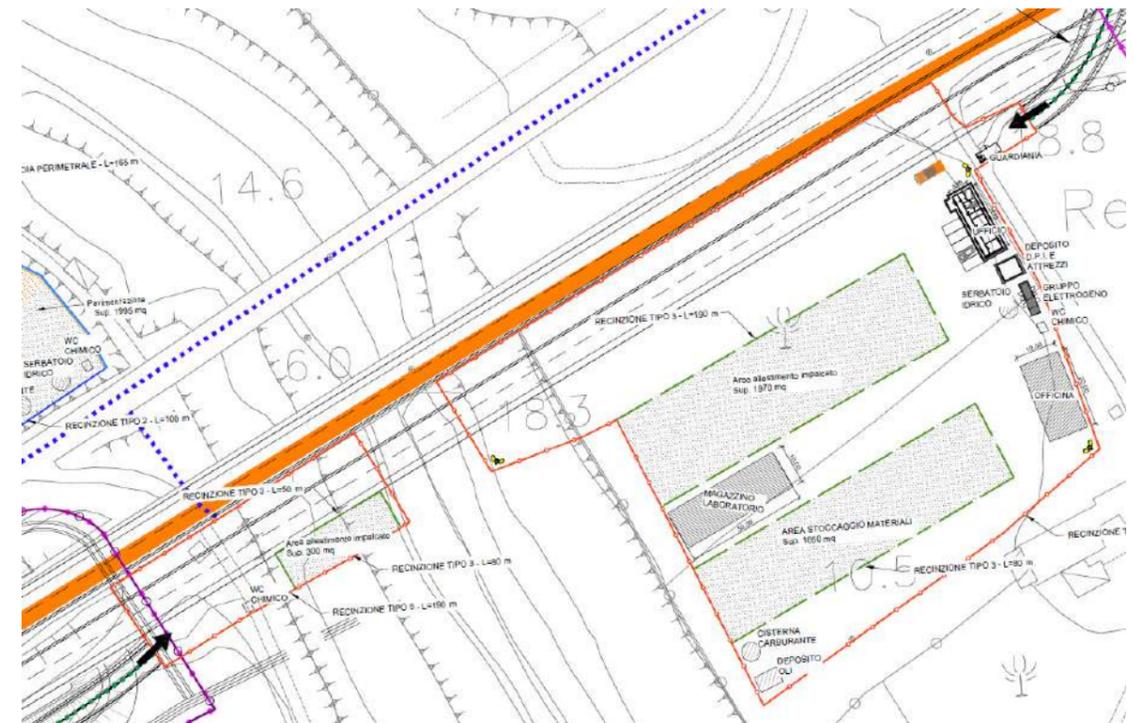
Planimetria del cantiere operativo CA.V.19.
